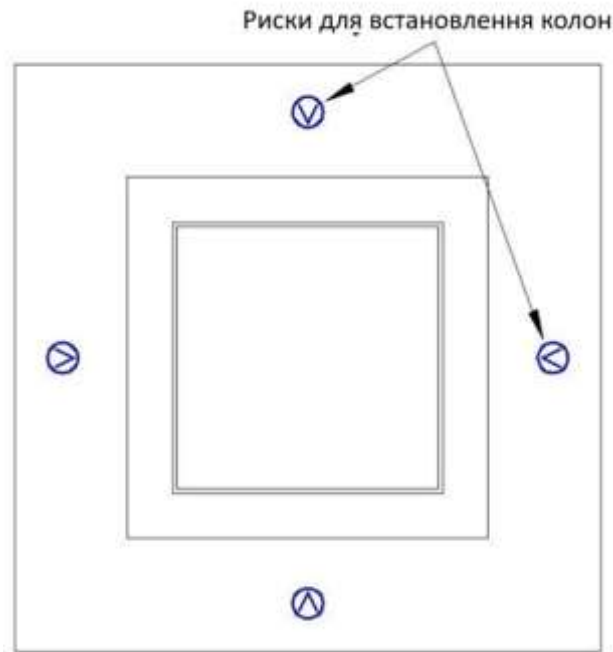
Фундамент (вид зверху) із закріпленими осями колон
